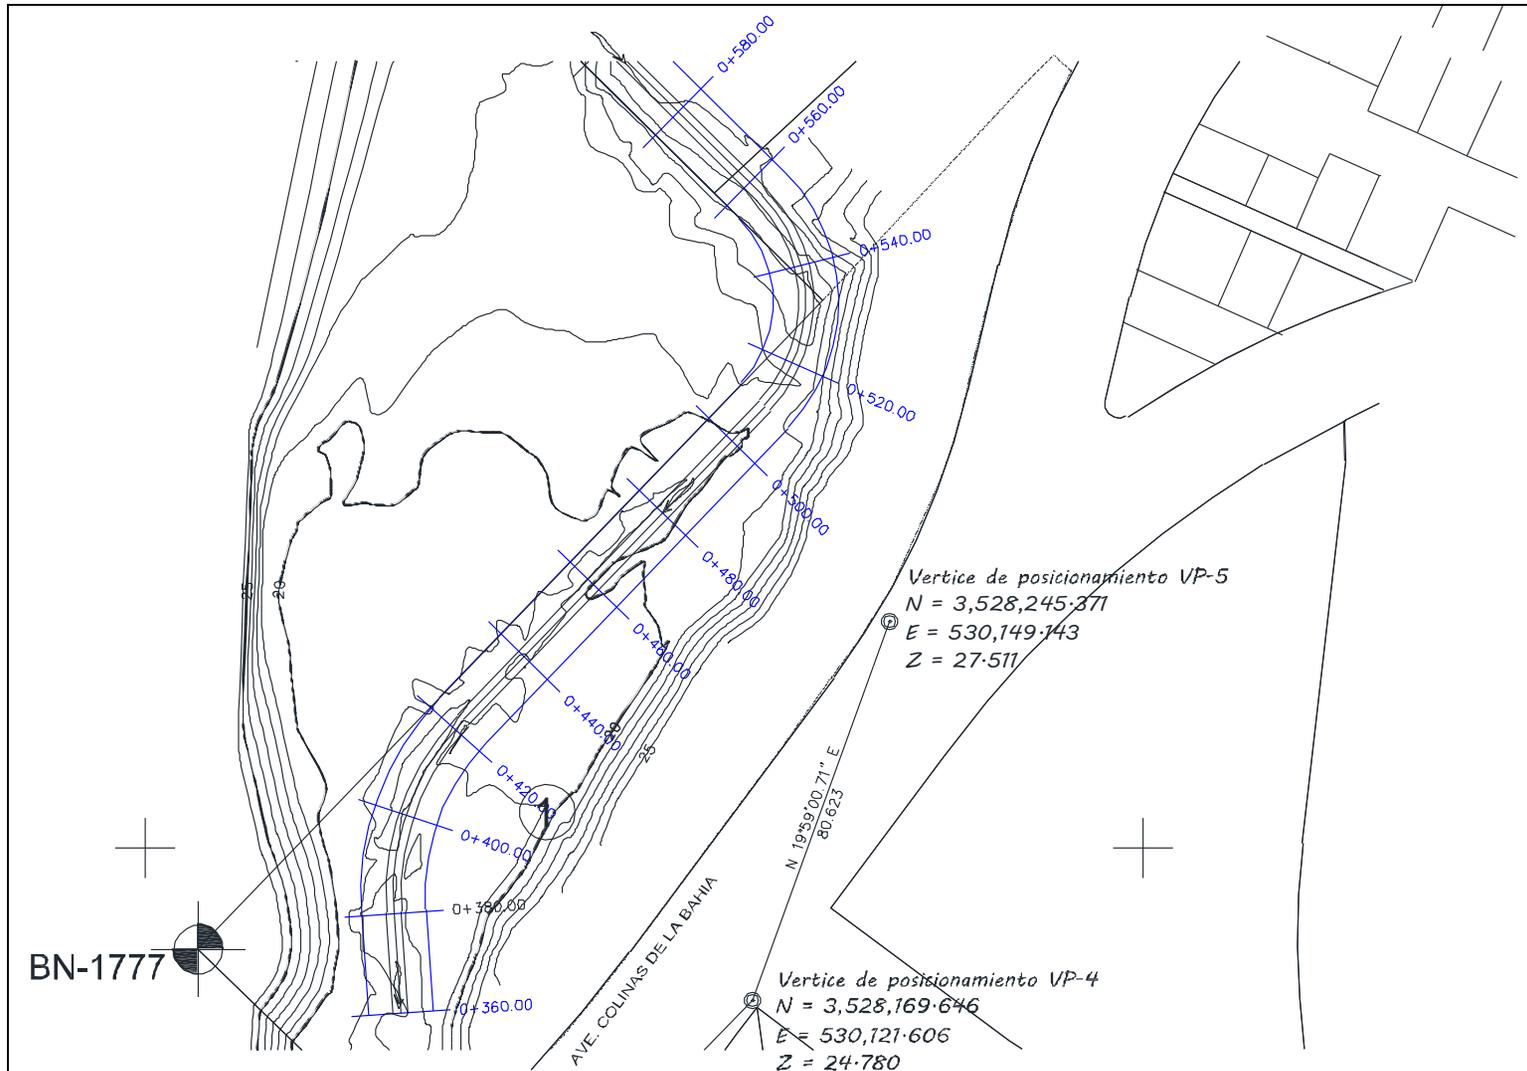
Plano que muestra la sección del Arroyo Cuatro Milpas que será canalizado (ver plano anexo).
